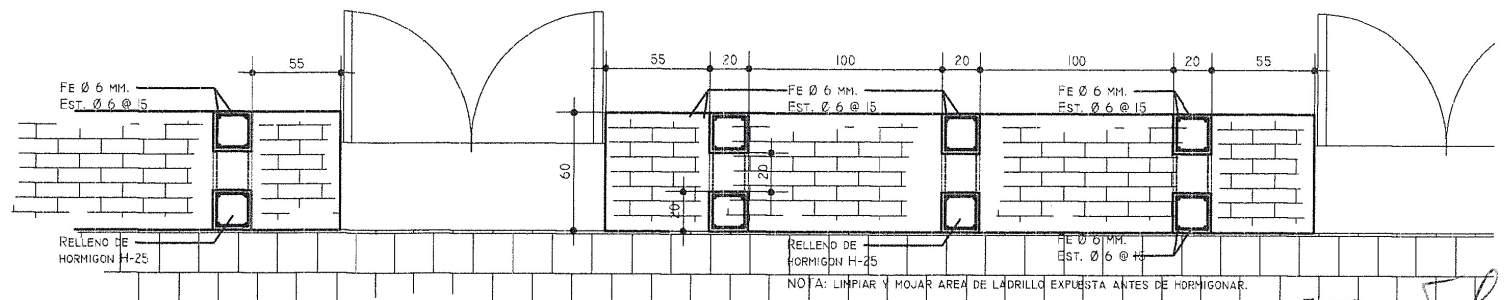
Aplicación de Solución en Muros de Albañilería del Tipo Marcos de Hormigón Armado, Planta
